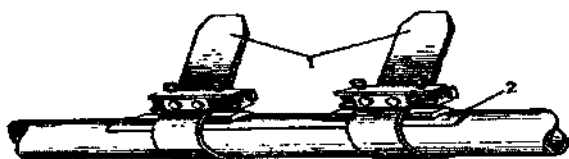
Ремонт довгої щільни двома універсальними бугелями з подовженою накладкою:
